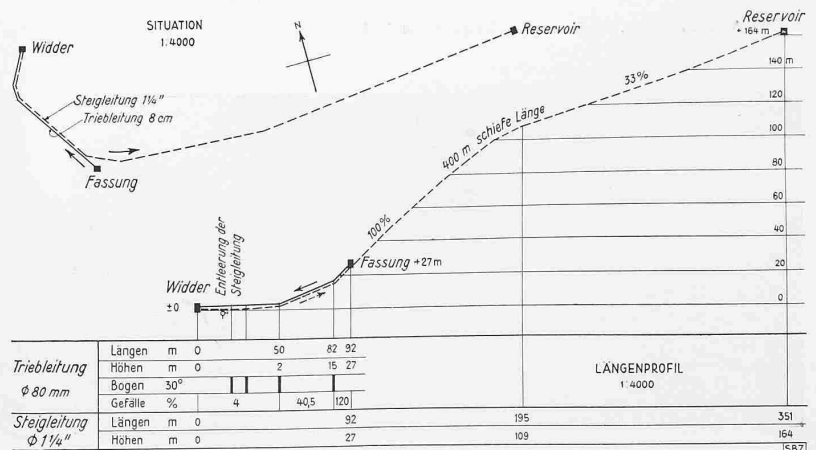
und 3. Lageplan und Längenprofil des hydraulischen Widders, 1:4000
